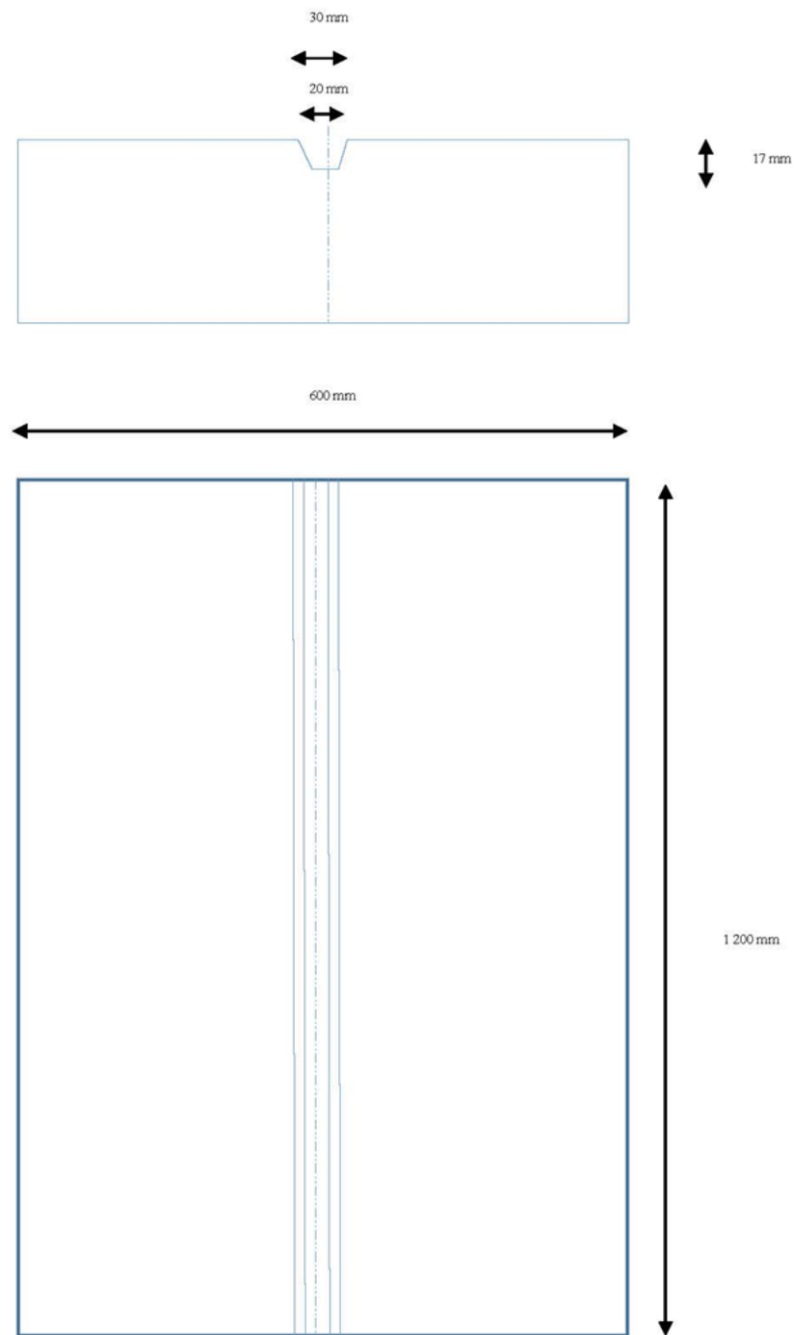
Panneaux à bossage en U 30 - (dimensions en mm)
